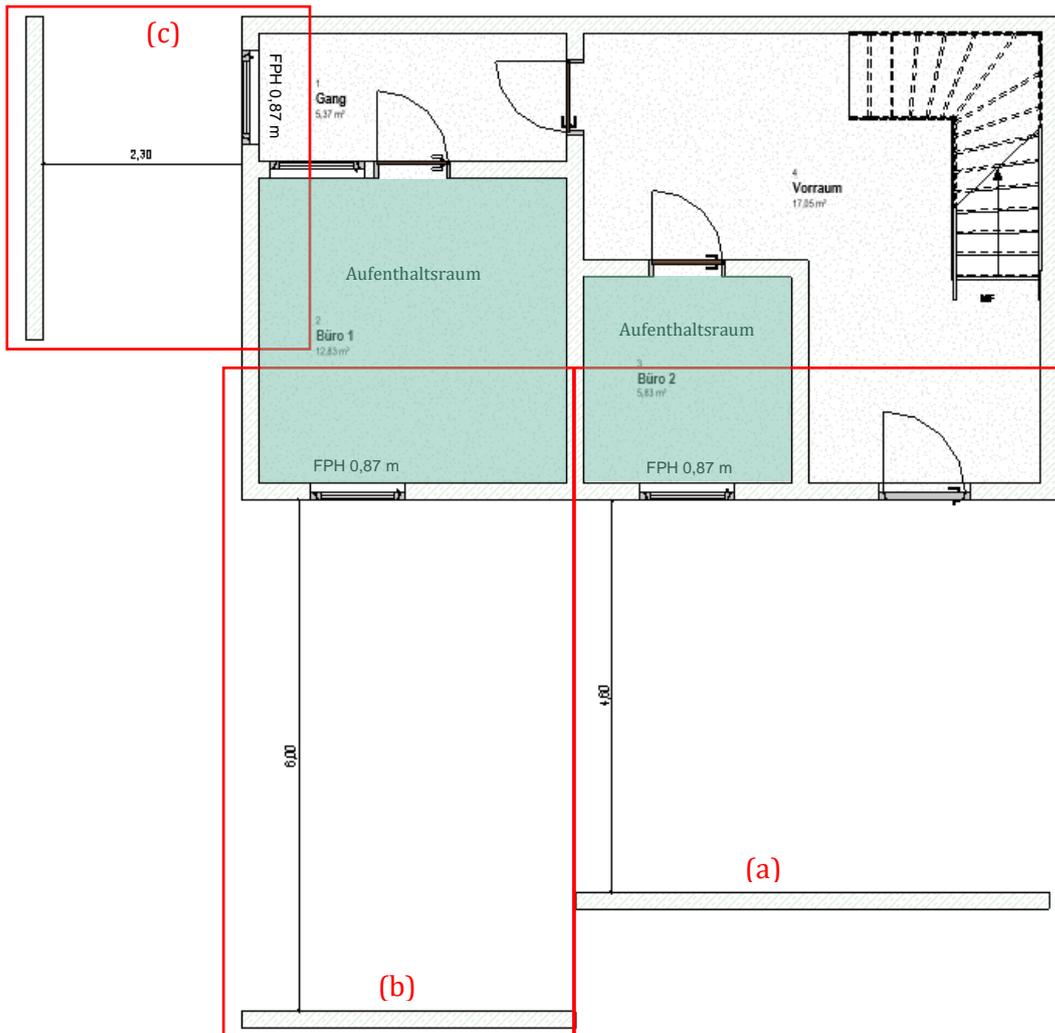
Grundriss BIM-Modell OIB RL - 9.1.2
